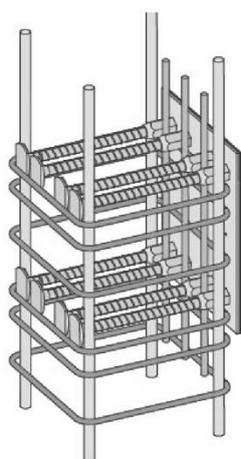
Bauseitige Bewehrung in der Schalung ergänzen
